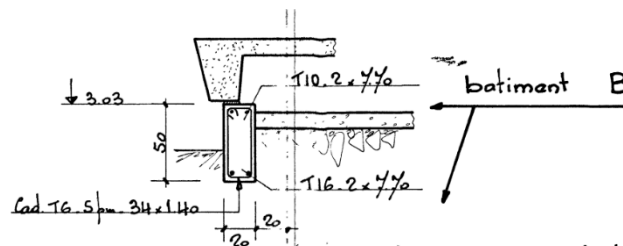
Extrait plan 73.705.B.C.1^B - PUIITS et SEMELLES
